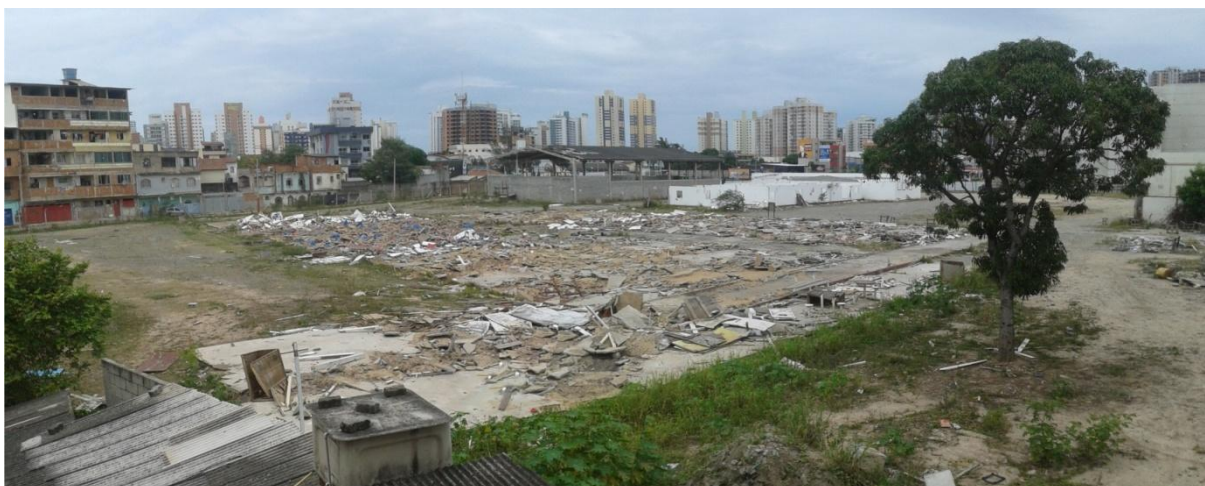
Terreno anexo à área do shopping, com material de demolição e entulho da construção.
